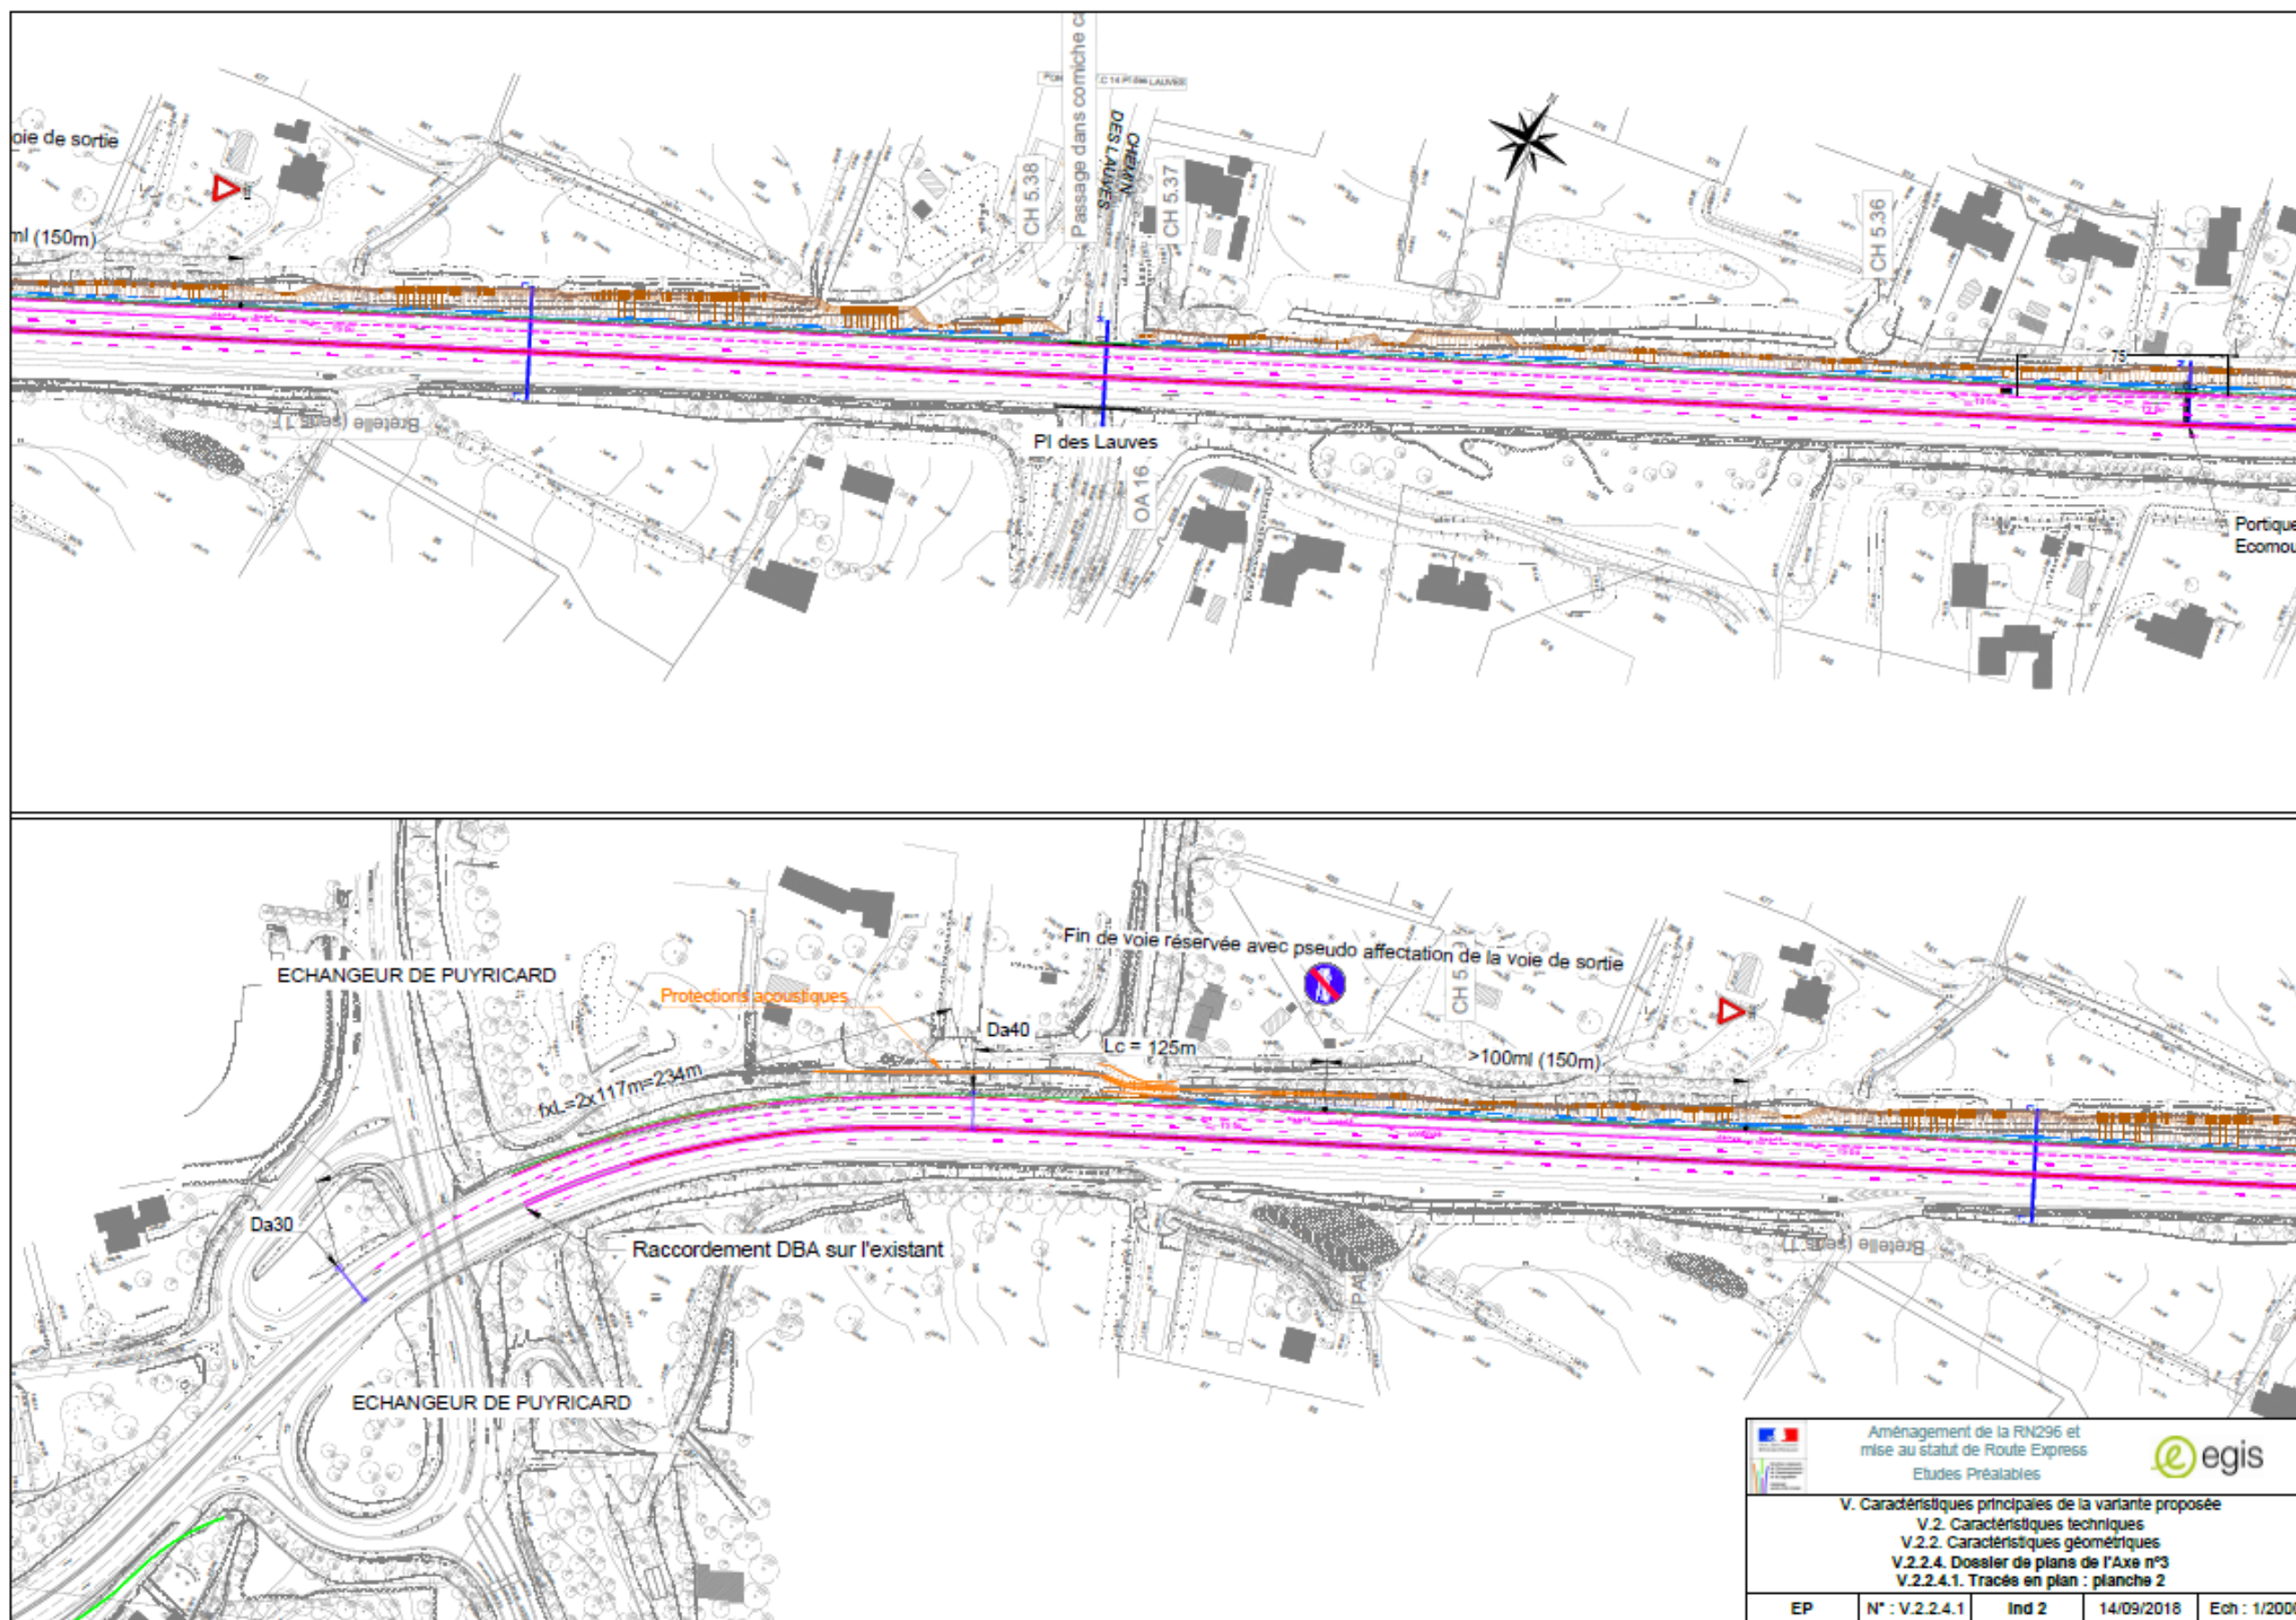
Vue en plan de l'aménagement de l'axe 3 – planche 2
